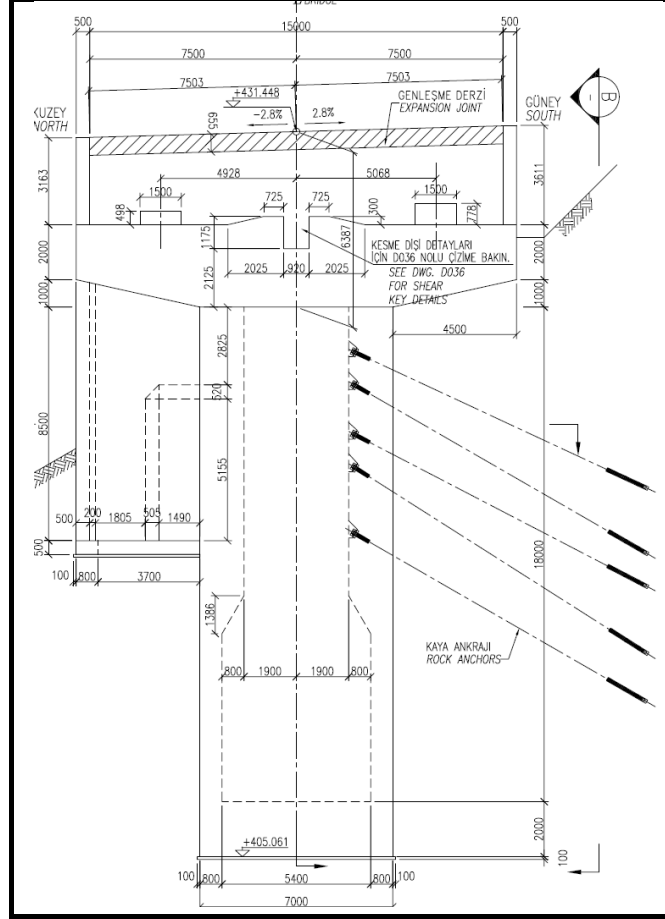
P2 ve P3 temelleri plan ve kesitleri, (DSİ, 2007)
